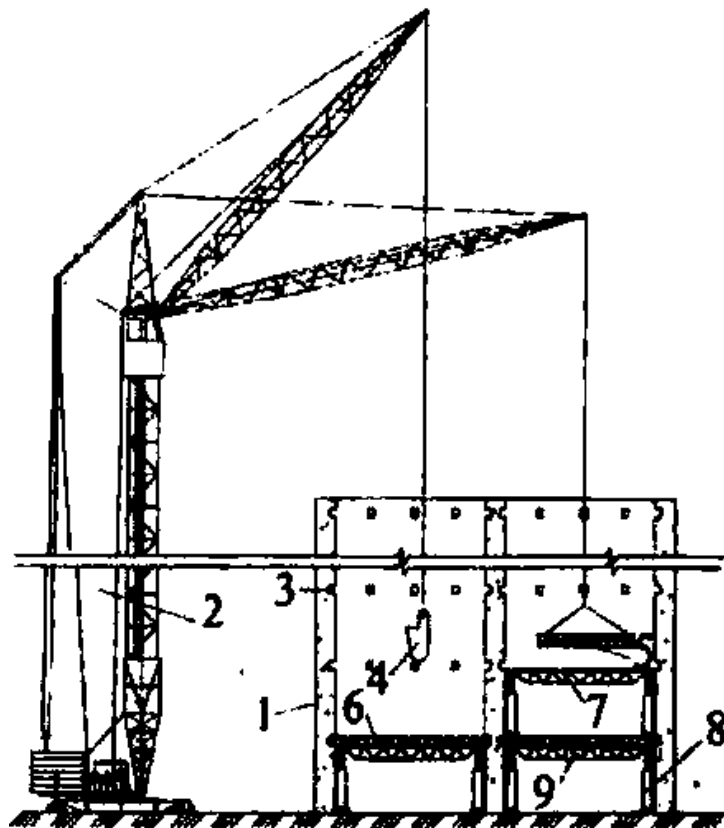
Бетонування міжповерхових перекриттів методом «знизу в гору»:
